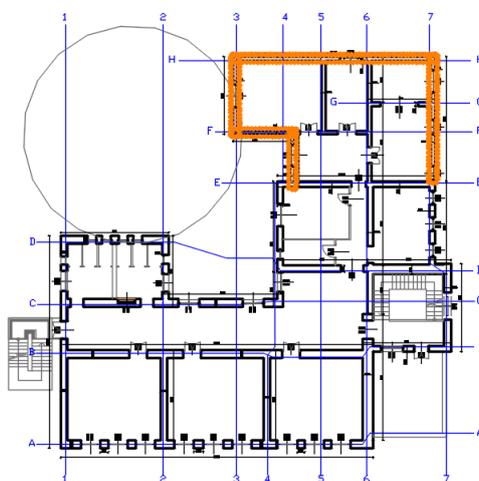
INDIVIDUAZIONE ELEMENTI DA RINFORZARE CON RETE TIPO TENAX – PLANO PRIMO
